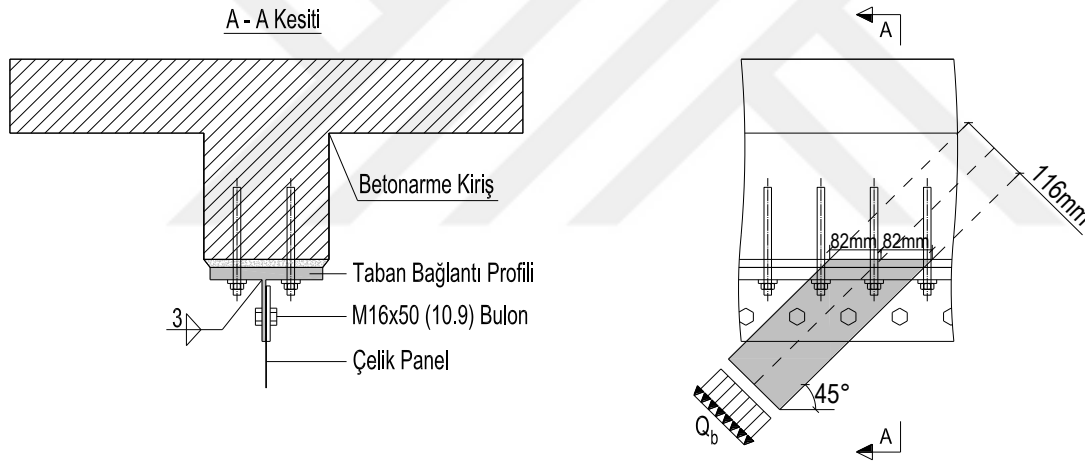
Betonarme elemanlarda donatı alanlarının tahkiki.
